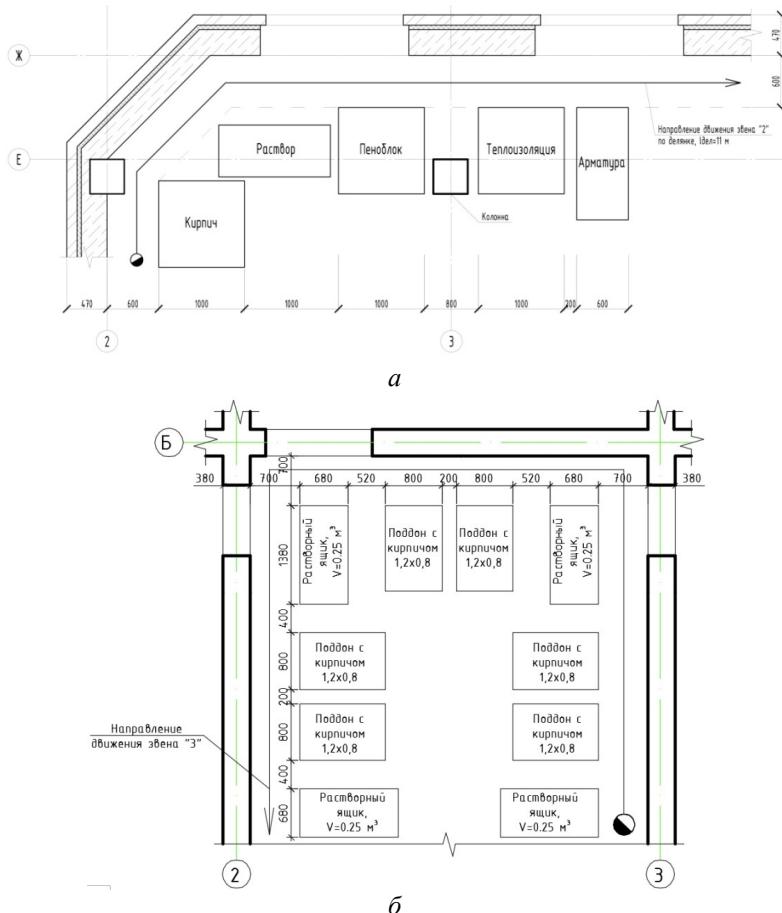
Примеры схем организации работ при кладке угла здания:
